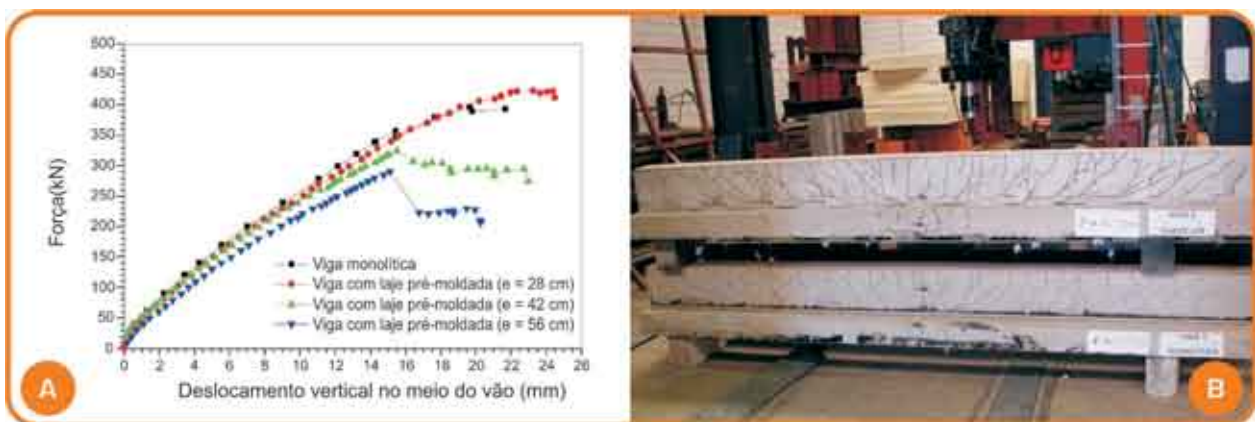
Ligação viga e lajes pré-moldadas com nichos: a) curvas força x flecha para vários espaçamentos dos nichos e b) comparação de panorama das fissuras de viga monolítica (embaixo) e viga com nichos espaçados de 280 mm (em cima) [ARAUJO (2002)].
